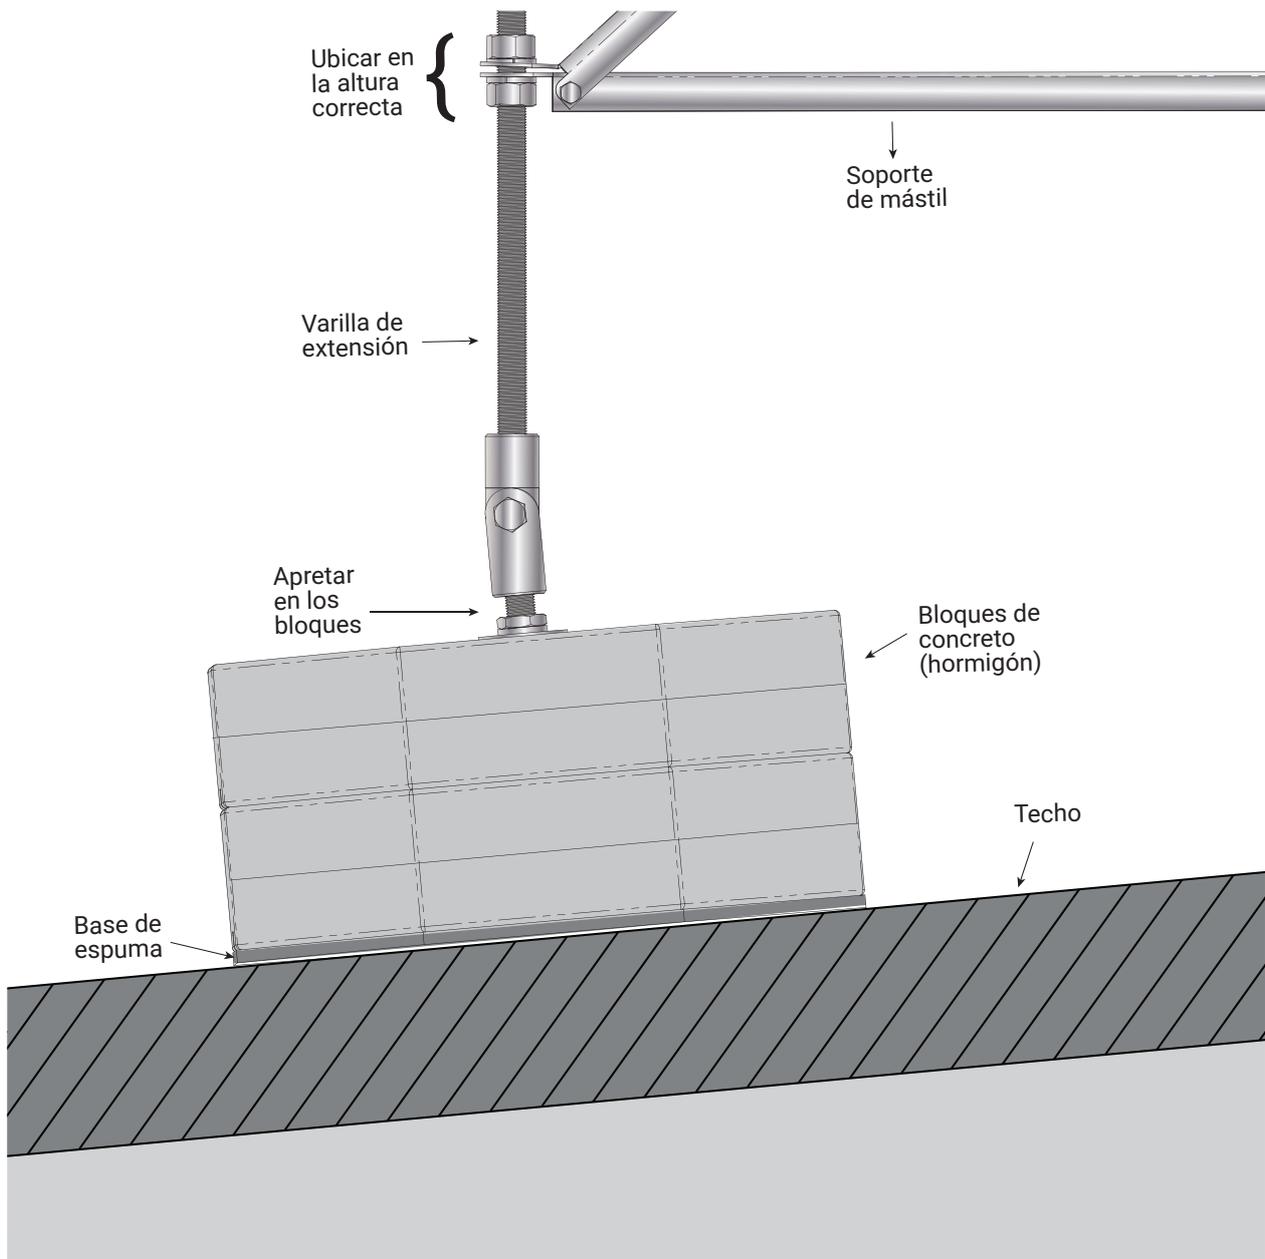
Varilla de extensión que se utiliza con el conjunto de bloques de concreto (hormigón) con bisagra y varilla
